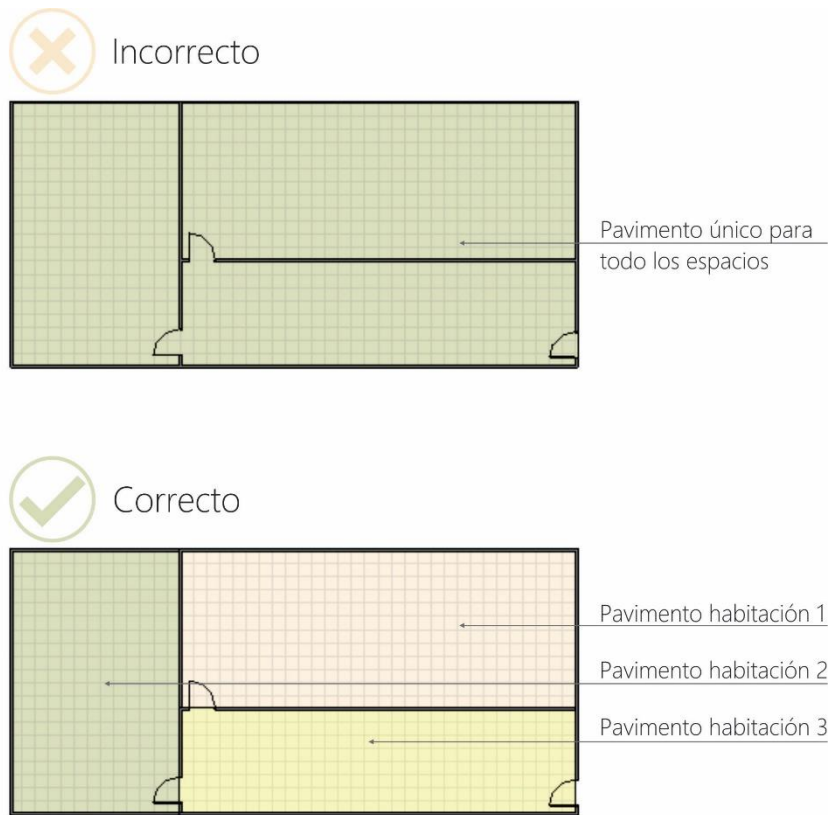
Vista en planta de ejemplo para modelado correcto de pavimentos.
